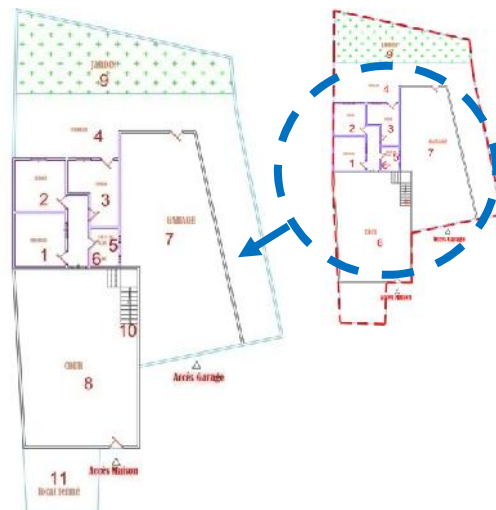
plan de la nouvelle construction en remplacement du chalet
